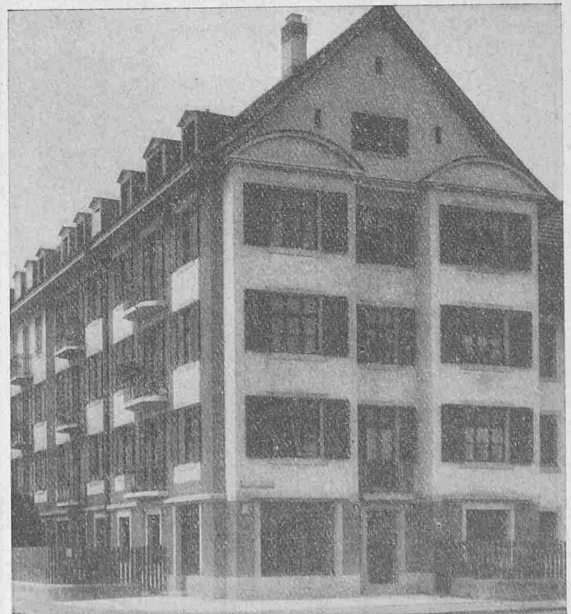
Grundriss und Abb. 2 Ansicht der Häuser an der Rufacherstrasse. (Vergl. Lageplan auf Seite 198.)
